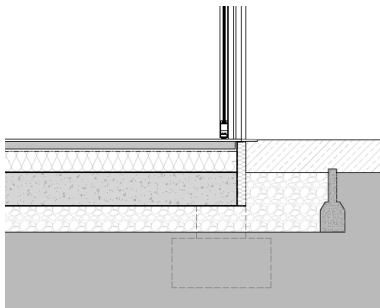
Pormenor construtivo do contacto entre o pavimento exterior e o edifício.
